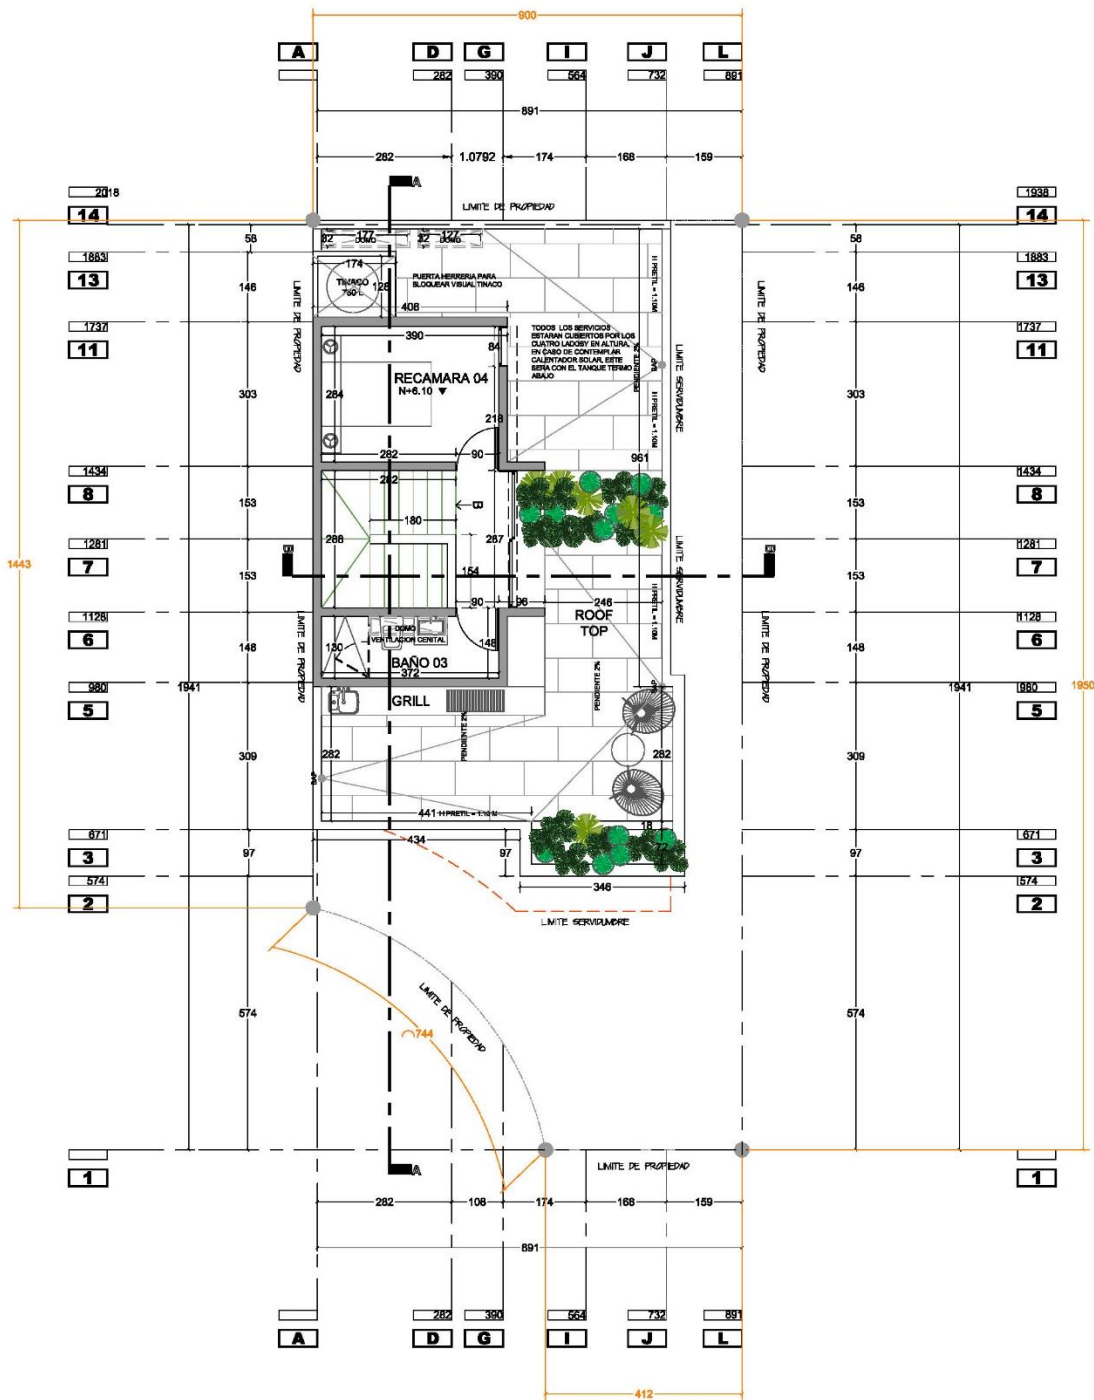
Planta roof top casa MO estado actual, elaboración propia (2020)
